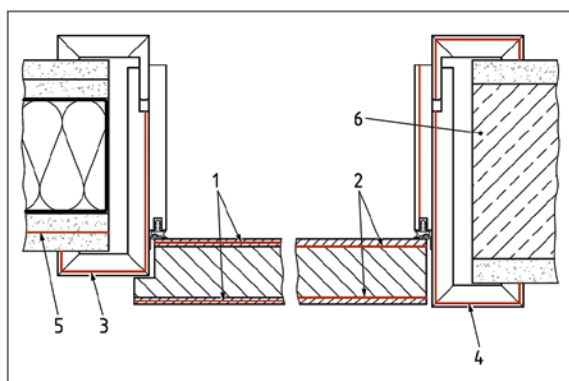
Horizontalschnitt einer Strahlenschutztüre mit Holzzarge [Quelle: Bild A.2, DIN 6834-1:2012-12, durch Verfasser leicht verändert]
